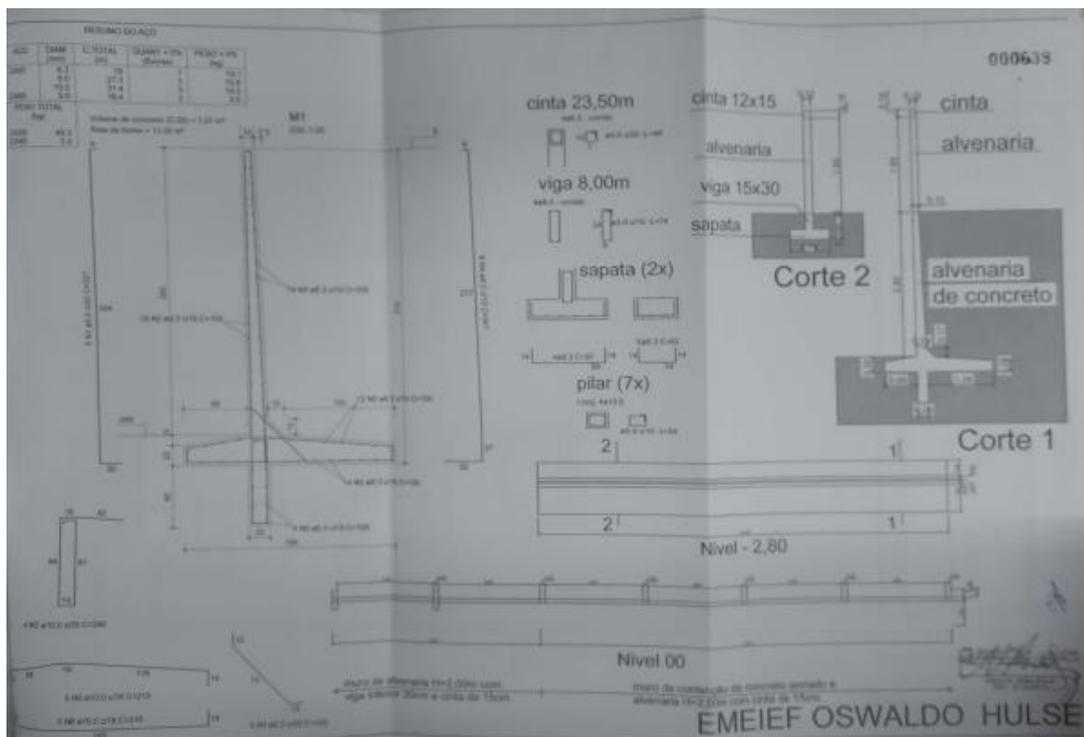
Planta de corte do muro de arrimo. (Fonte: PMC)
